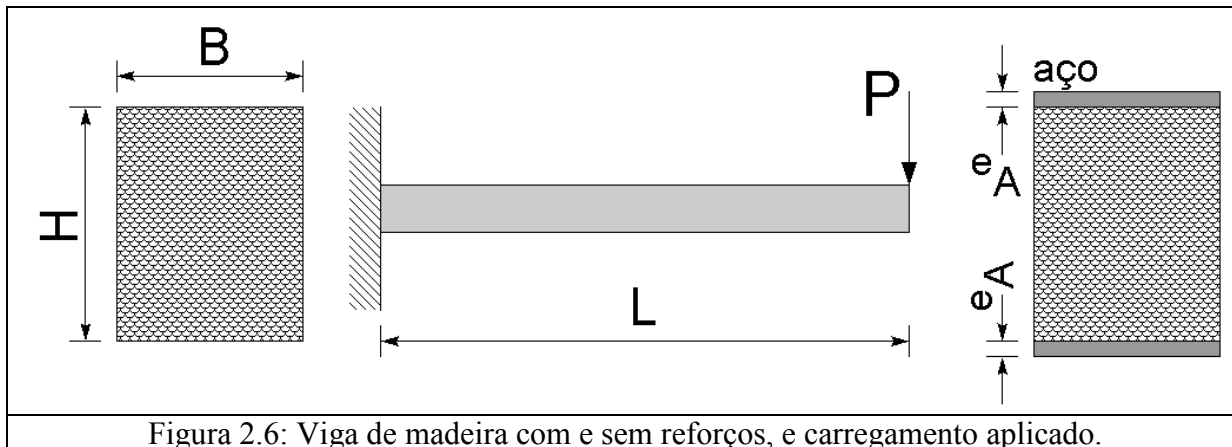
Viga de madeira com e sem reforços, e carregamento aplicado.
